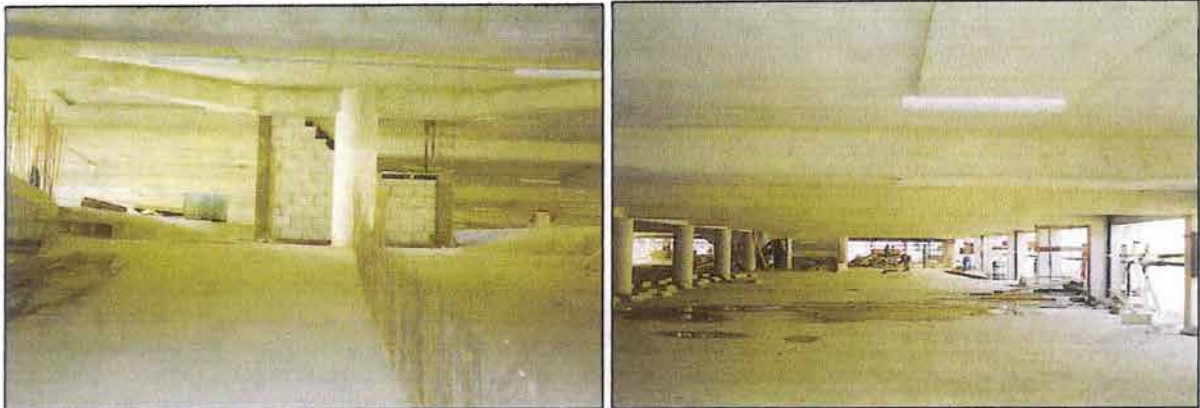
Aspecto interior de la estructura en los pisos uno y planta baja.
